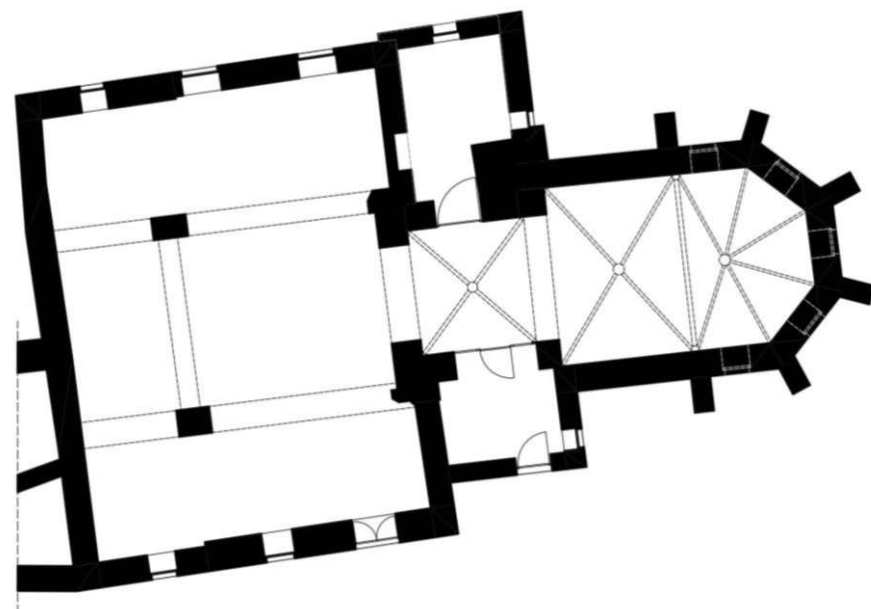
Schlosskapelle, Bestandsplan - Erdgeschoss, M 1:200
